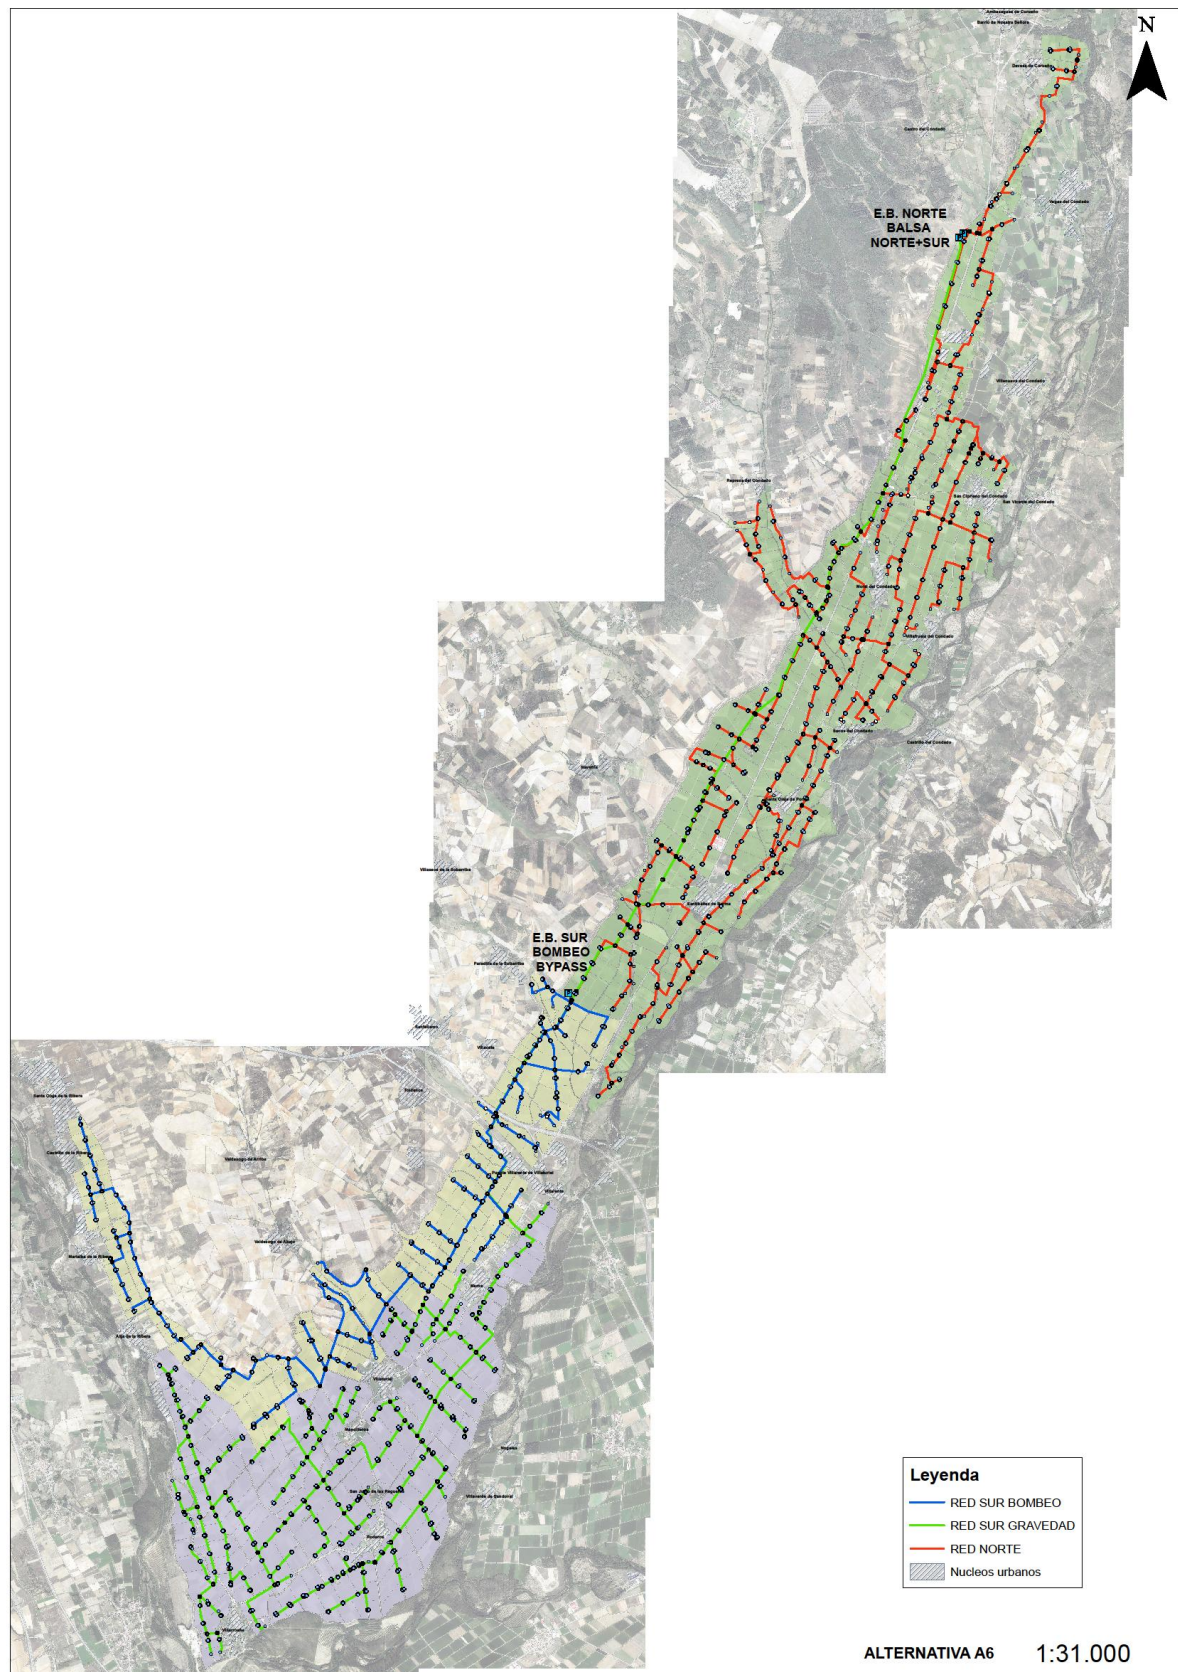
Ubicación de las infraestructuras en la Alternativa 6
